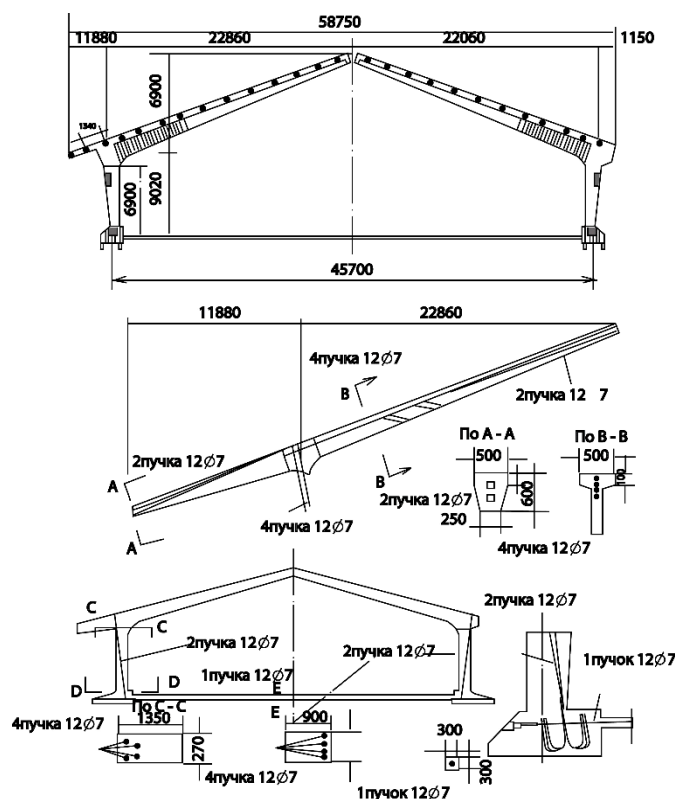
Схема рамного каркаса хранилища в Анапе (Нигерия)
